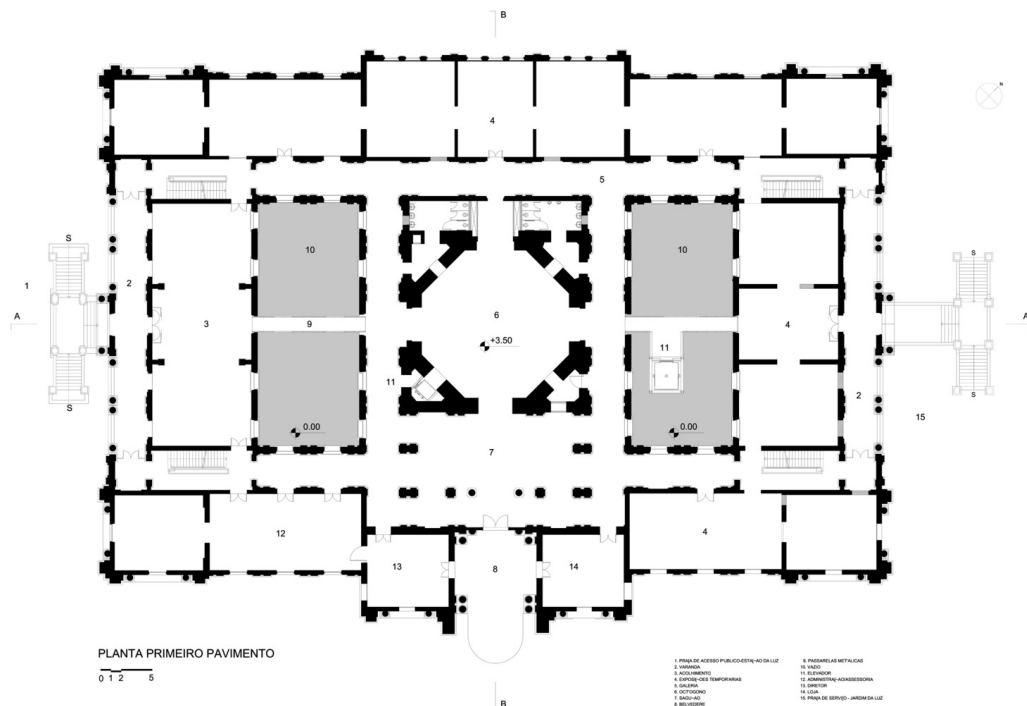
Planta do primeiro pavimento do edifício da Pinacoteca, após o projeto de reforma proposto por Paulo Mendes da Rocha, Eduardo Colonelli e Weliton Ricoy Torres. Fonte: <https://www.archdaily.com.br/br/787997/pinacoteca-do-estado-de-sao-paulo-paulo-mendes-da-rocha>, acesso em 10 de outubro de 2018.
